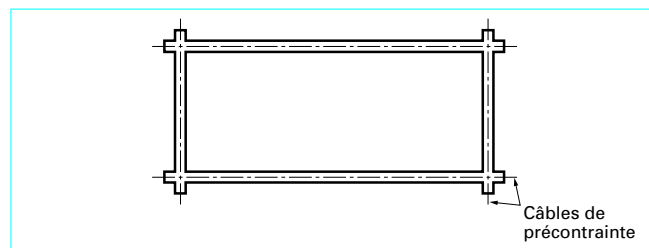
Réservoir rectangulaire. Schéma de câblage horizontal
